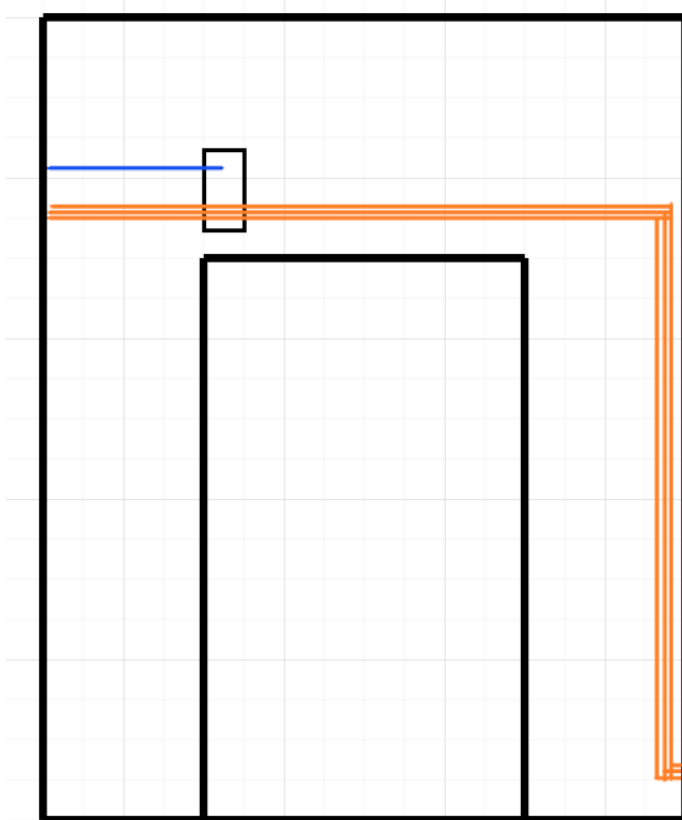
Схема прокладки проводов по стене над дверью, которую видно из комнаты.
